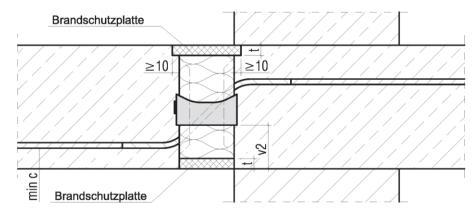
Schöck Isokorb® Typ Q (Ausführungsvariante A) gem. Abschnitt 3.1.2
